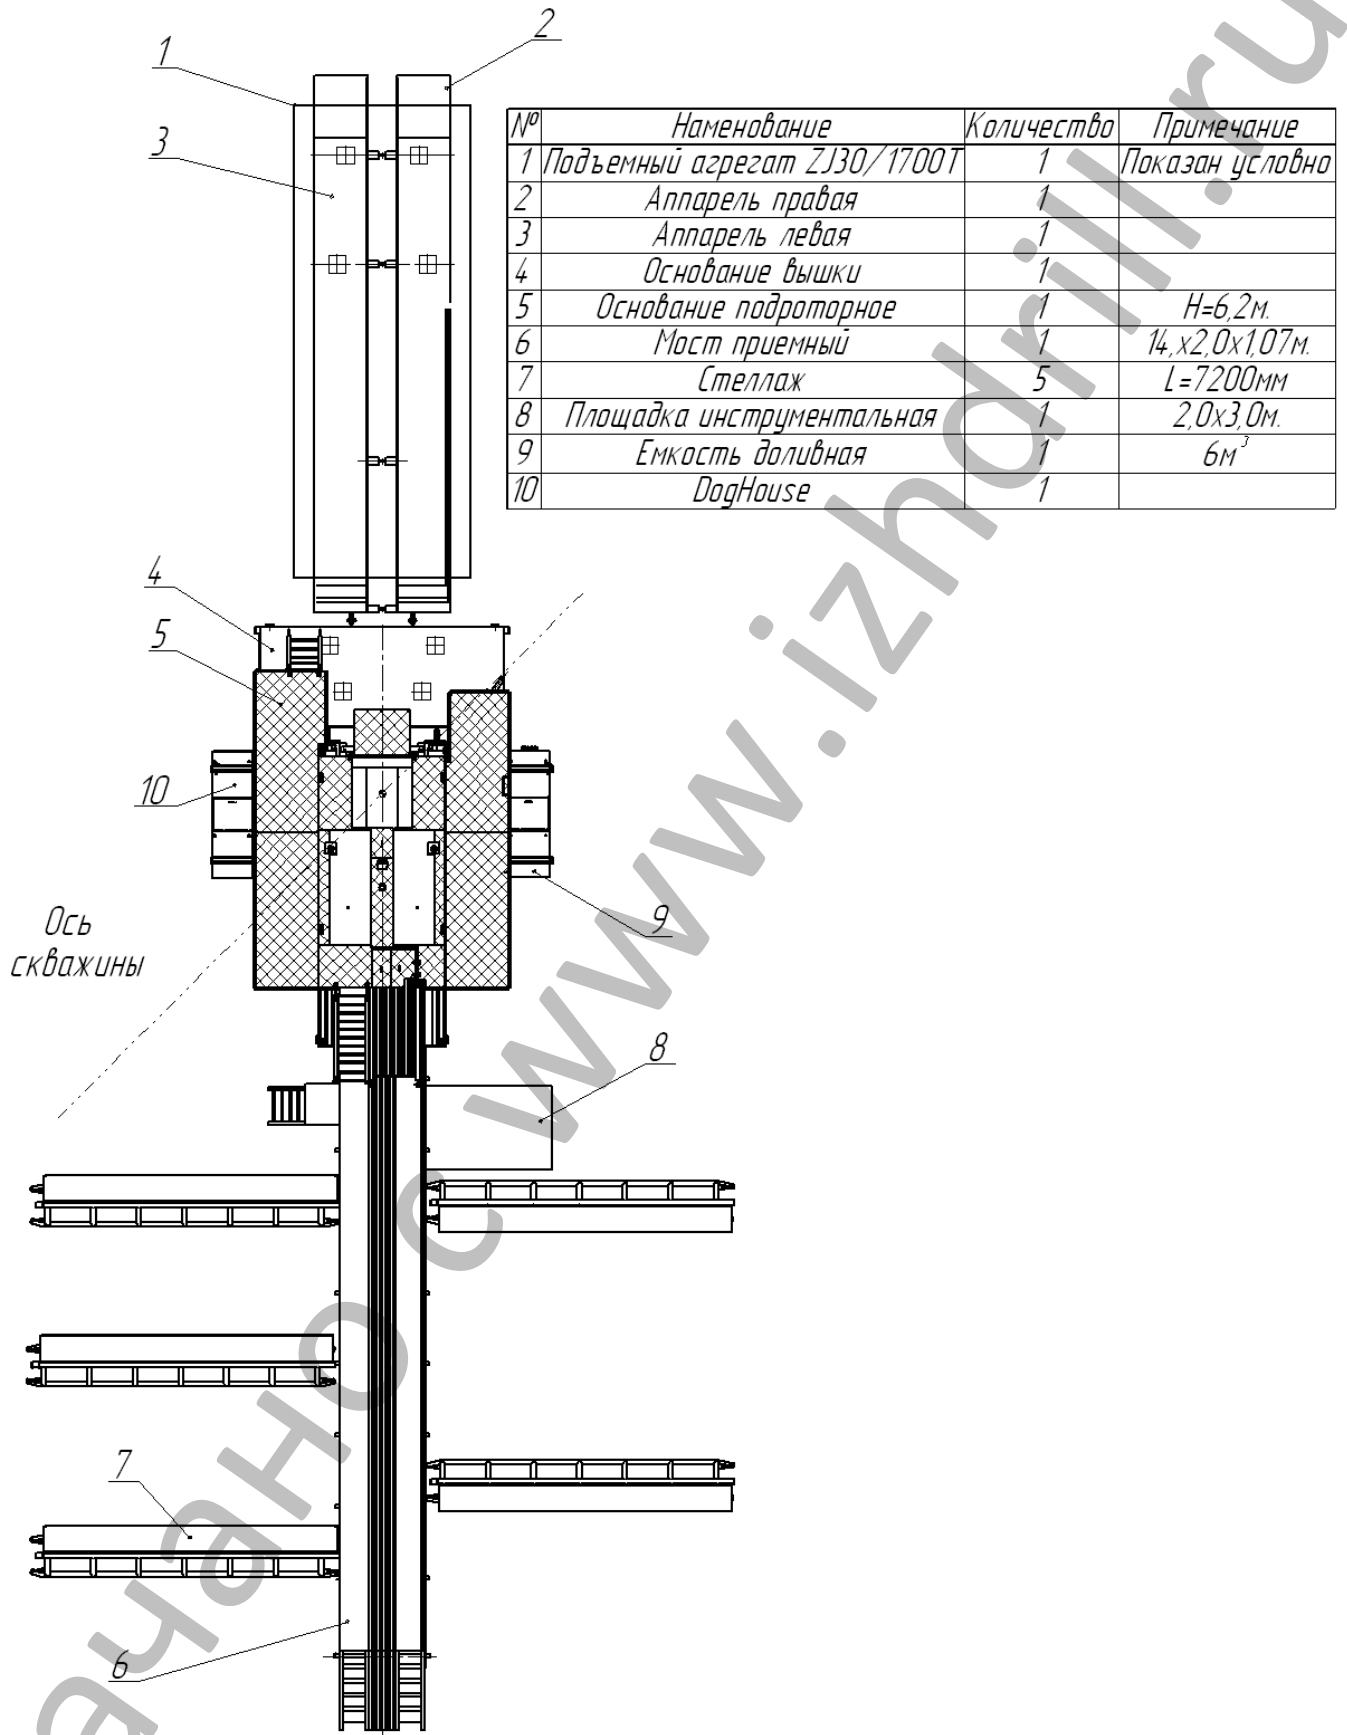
Схема расположения буровой прицепной установки ZJ30/1700T с комплектом металлоконструкций АПП
